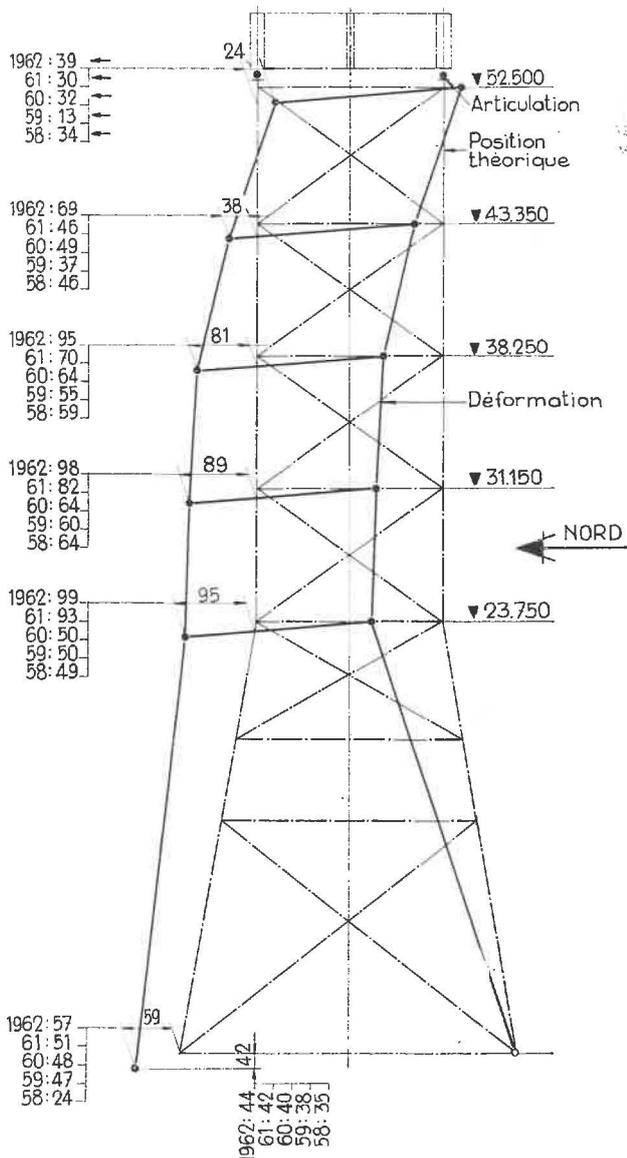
Déformation des deux montants dans un plan nord-sud.
